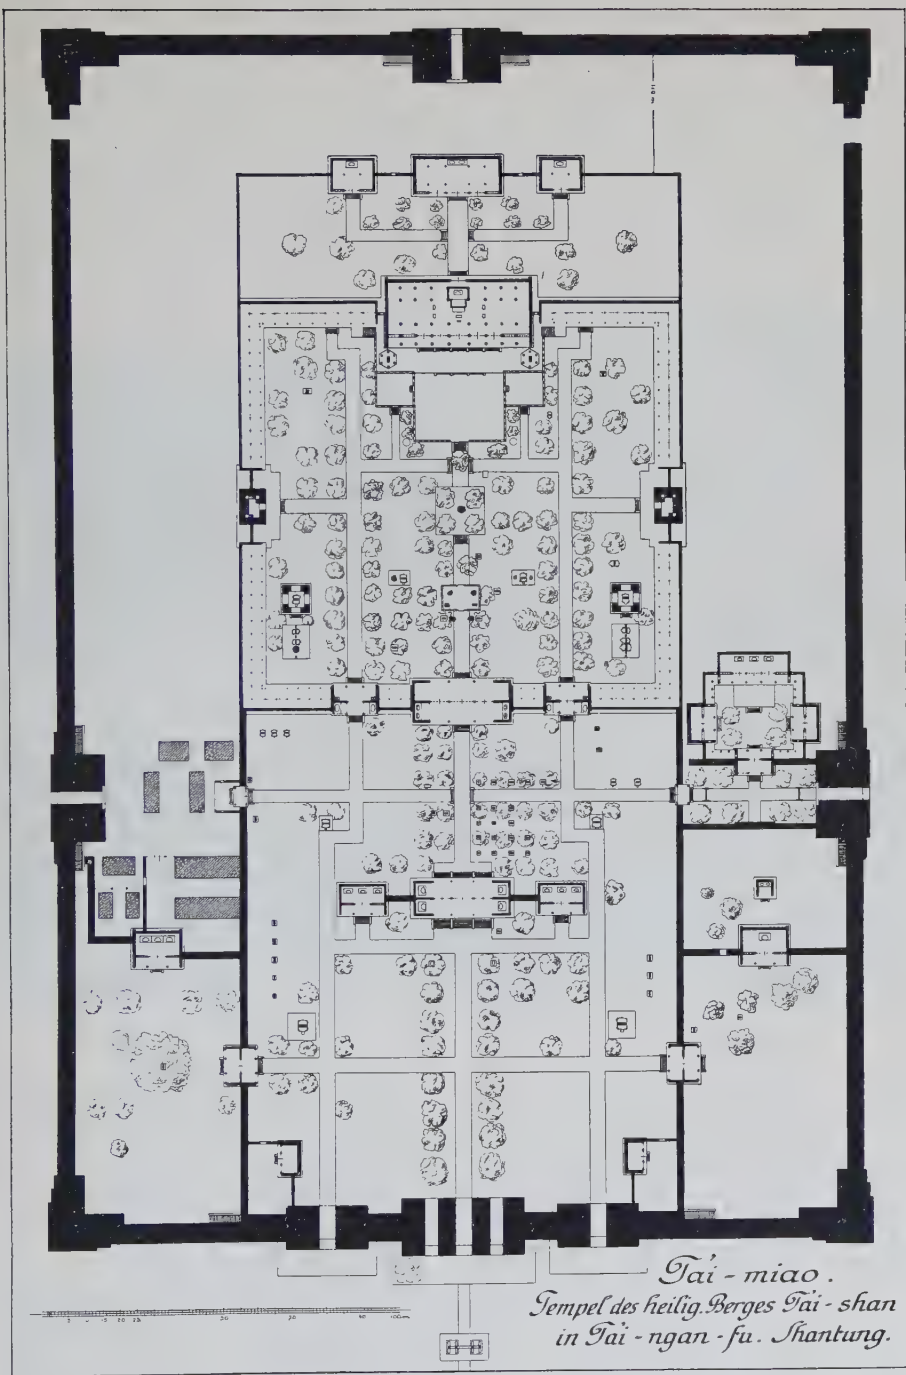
Grundriss des T'ai-miao, des Tempels am Fuss des heiligen Berges T'ai-shan in Shantung.
